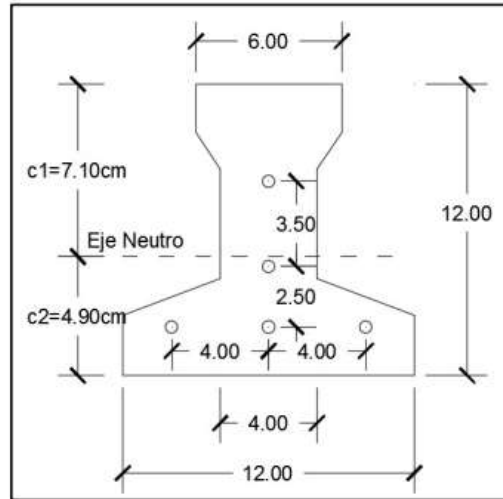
Sección transversal de la viga, Fuente: Elaboración Propia
